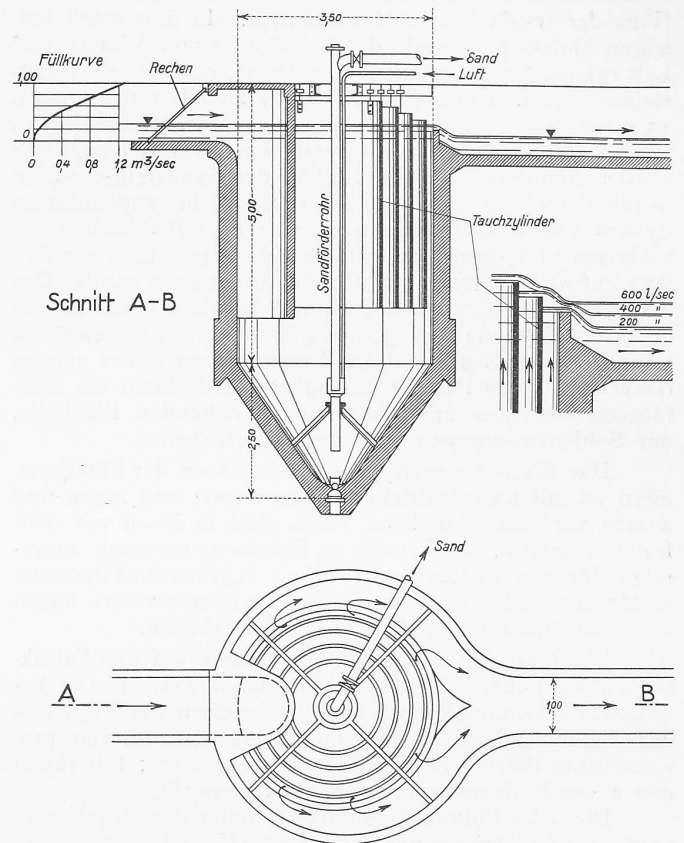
Vertikal durchflossener Sandfang, Grundriss und Schnitt. — 1 : 125.
